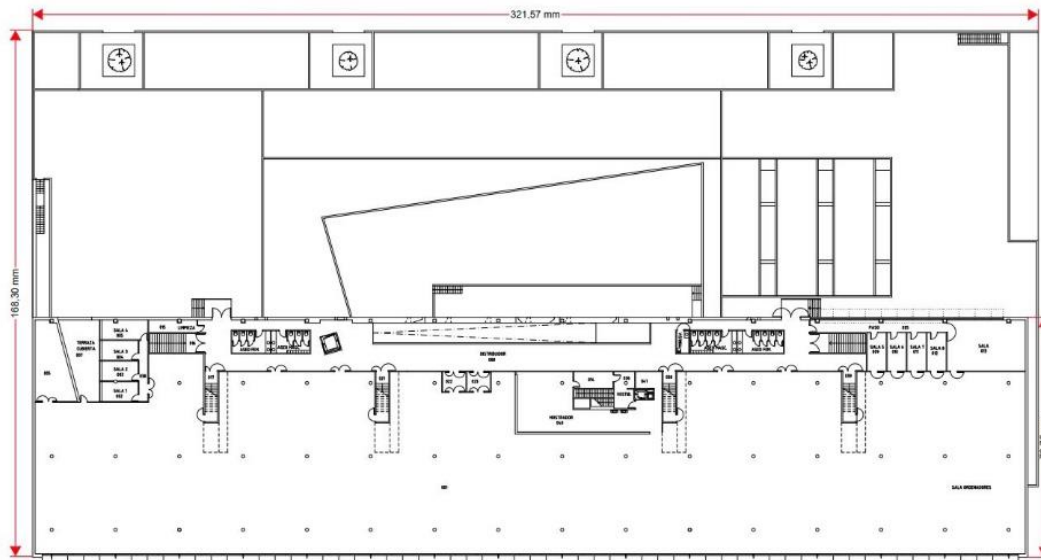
Medidas de las paredes exteriores de la primera planta de la Biblioteca
